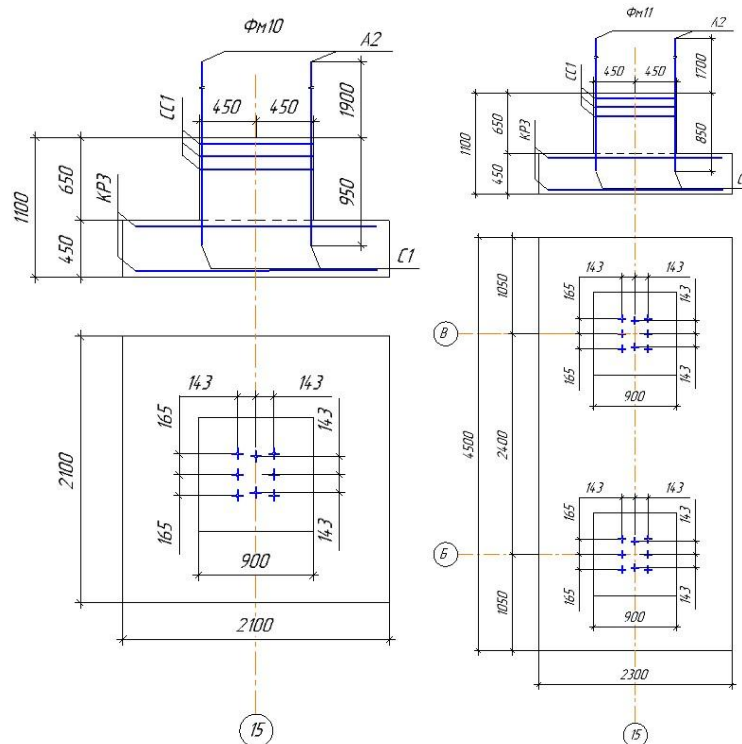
Схема расположения арматурных изделий в фундаментах ФМ10 и ФМ11
